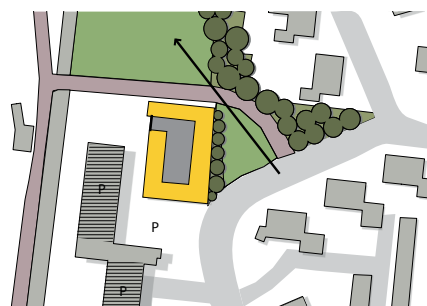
Type 4 - nog meer overzicht door verwijderen garageboxen
